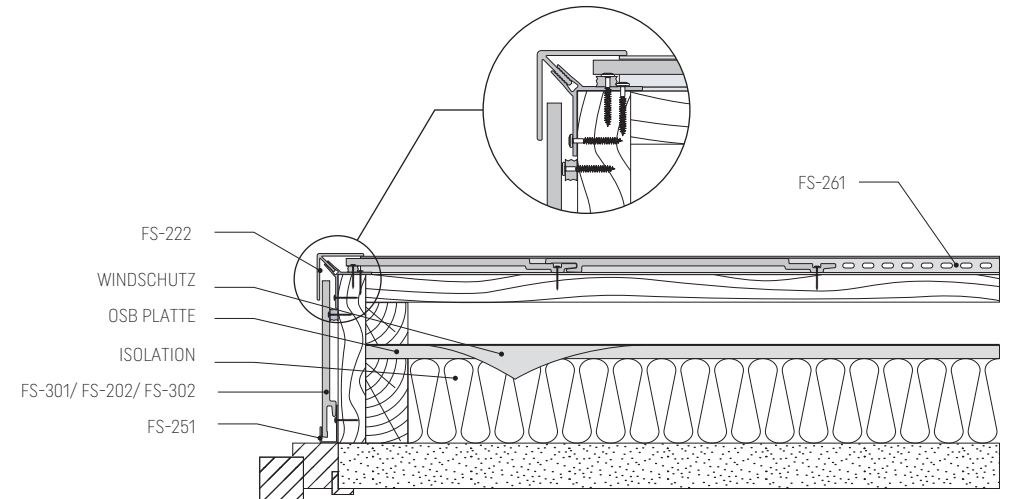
KERRAFRONT Detail, Ecke, Holzelemente an der Mauer mit Wärmeolammungsschicht - horizontaler Schnitt
